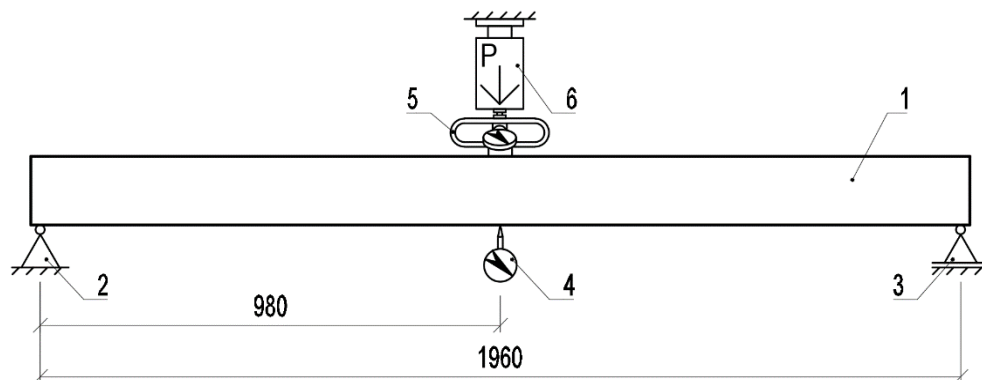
Схема розміщення елементів випробувальної установки: 1 - балка; 2 - шарнірно-нерухома опора; 3 - шарнірно-рухома опора; 4 - індикатор; 5 - динамометр; 6 - домкрат.
